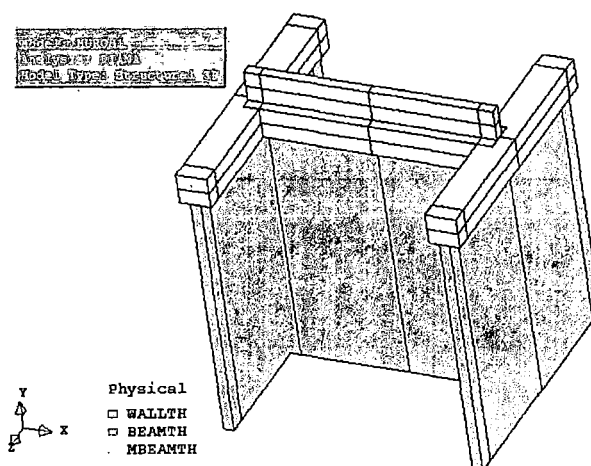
Geometría del modelo del espécimen 04 (rojo: muro de concreto, anaranjado: viga de concreto, amarillo: viga metálica).
